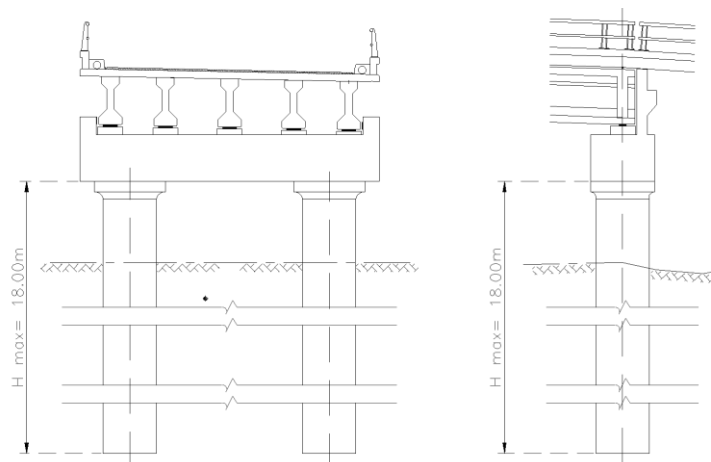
Sección tipo de apoyo extremo no. 1 y 8.
